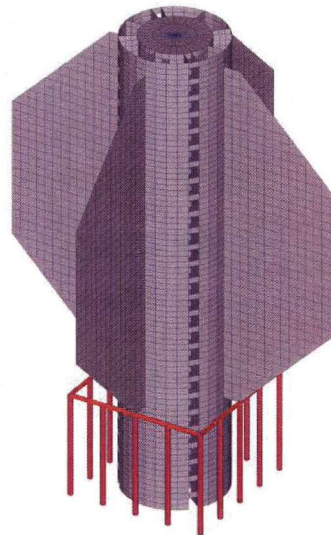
Вариант 1 конструктивной схемы здания книгохранилища (несущими элементами, воспринимающими нагрузку от элементов каркаса, являются круглый железобетонный ствол с 4-мя диафрагмами и трубобетонные колонны)
